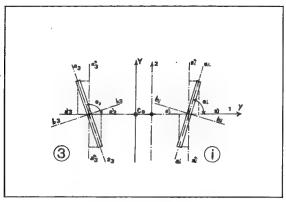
١١) يبين مسقطاً لمبنى عال ، يضم جدران أفقية ورأسية وماثلة ويتعرض لحمل أفقى مقداره (W).
